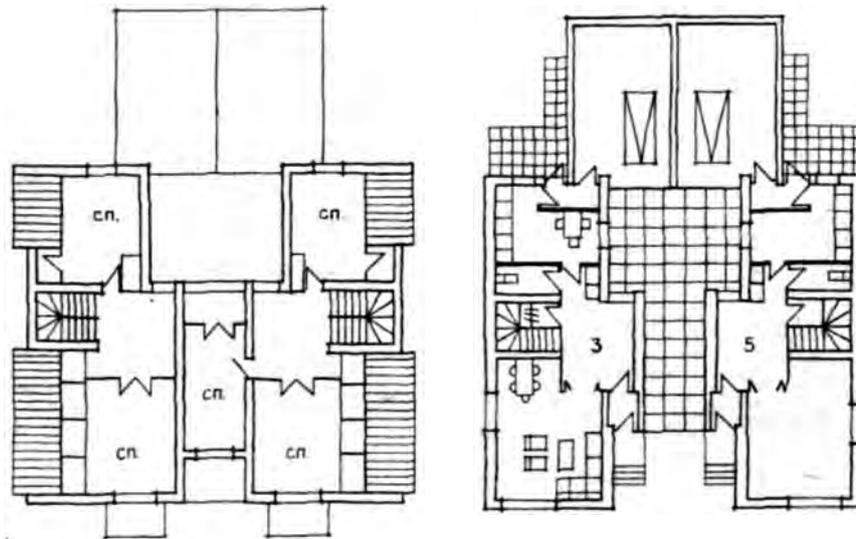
Планы второго и первого этажей мансардного двухквартирного дома с трех- и пятикомнатными квартирами
